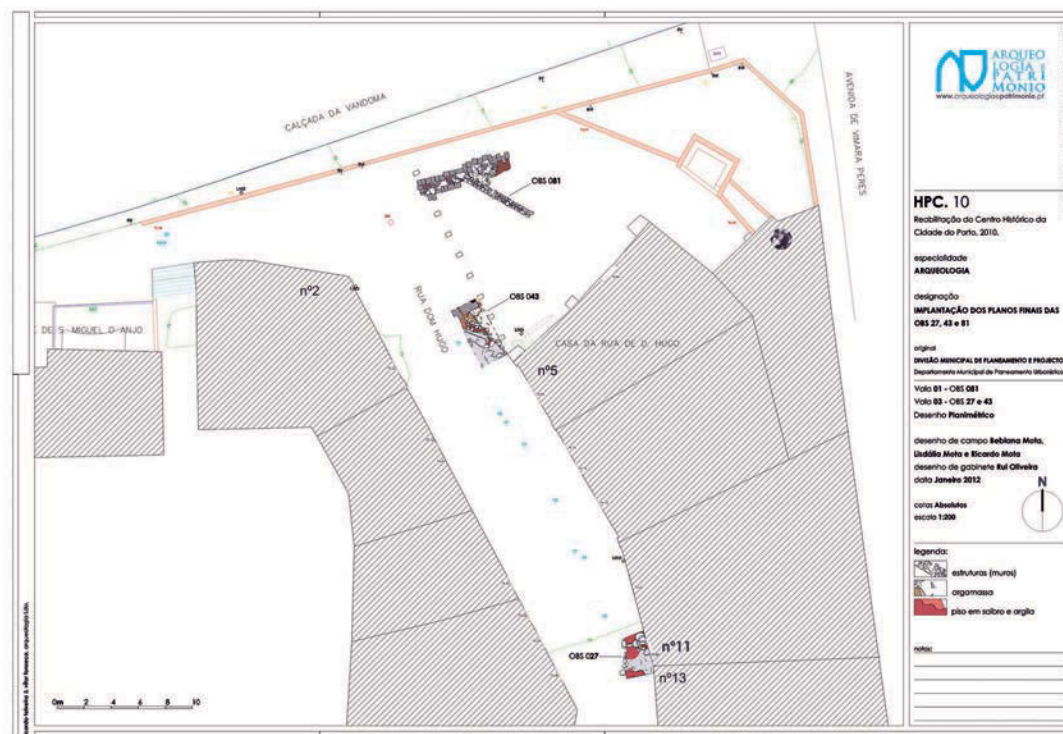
Planta com implantação das principais estruturas detetadas na faixa norte da Rua D. Hugo.
